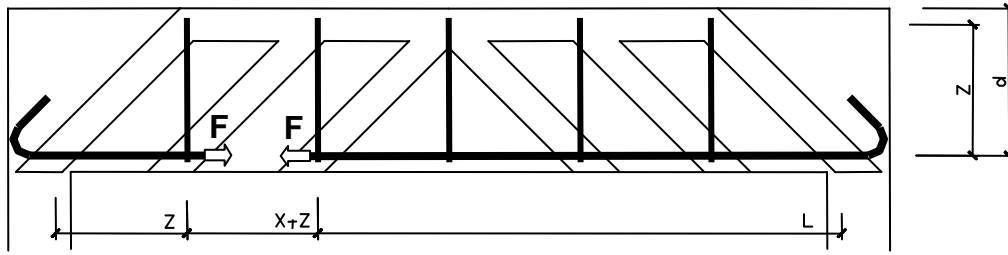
Traction dans les aciers longitudinaux de la poutre
